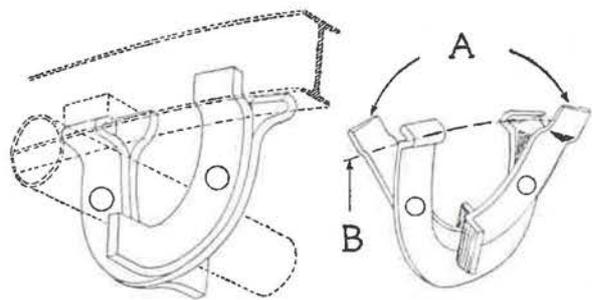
Etrier utilisé pour suspendre des poutrelles en porte-à-faux à des cintres de soutènement.
